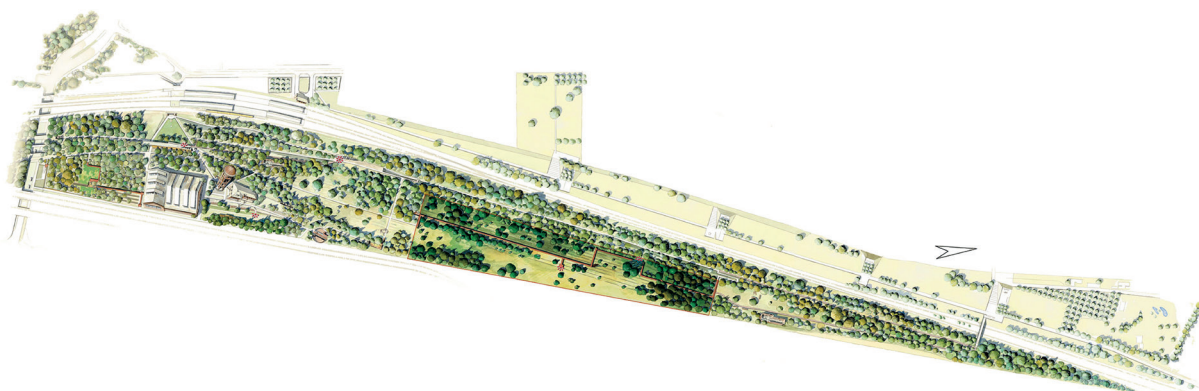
Генеральный план парка Шенеберг-Зюдгеланде в Берлине
